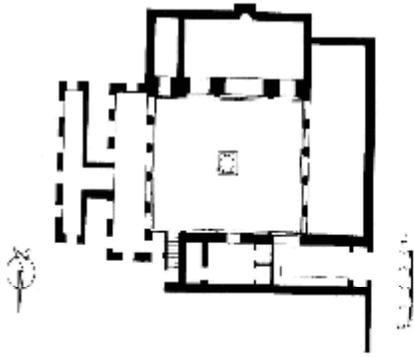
مسقط أفقي لمسجد الشرايين بفاس القديمة
